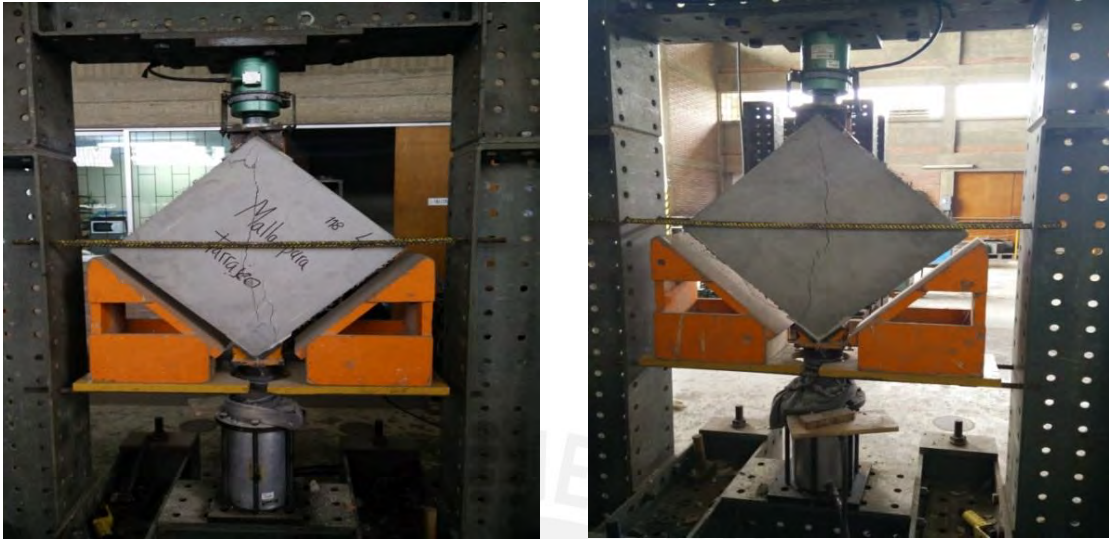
Falla por tracción diagonal de murete N° 4 (Tipo M2)
